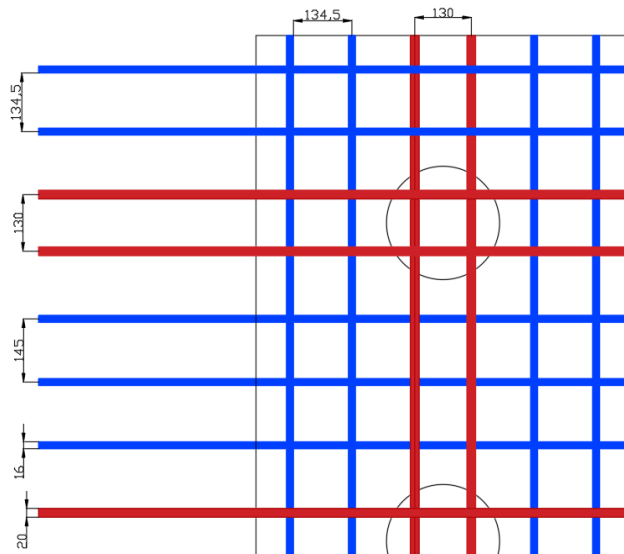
Armadura Pila 2 lado corto, Transversal y longitudinal, Espaciado entre las diferentes barras
